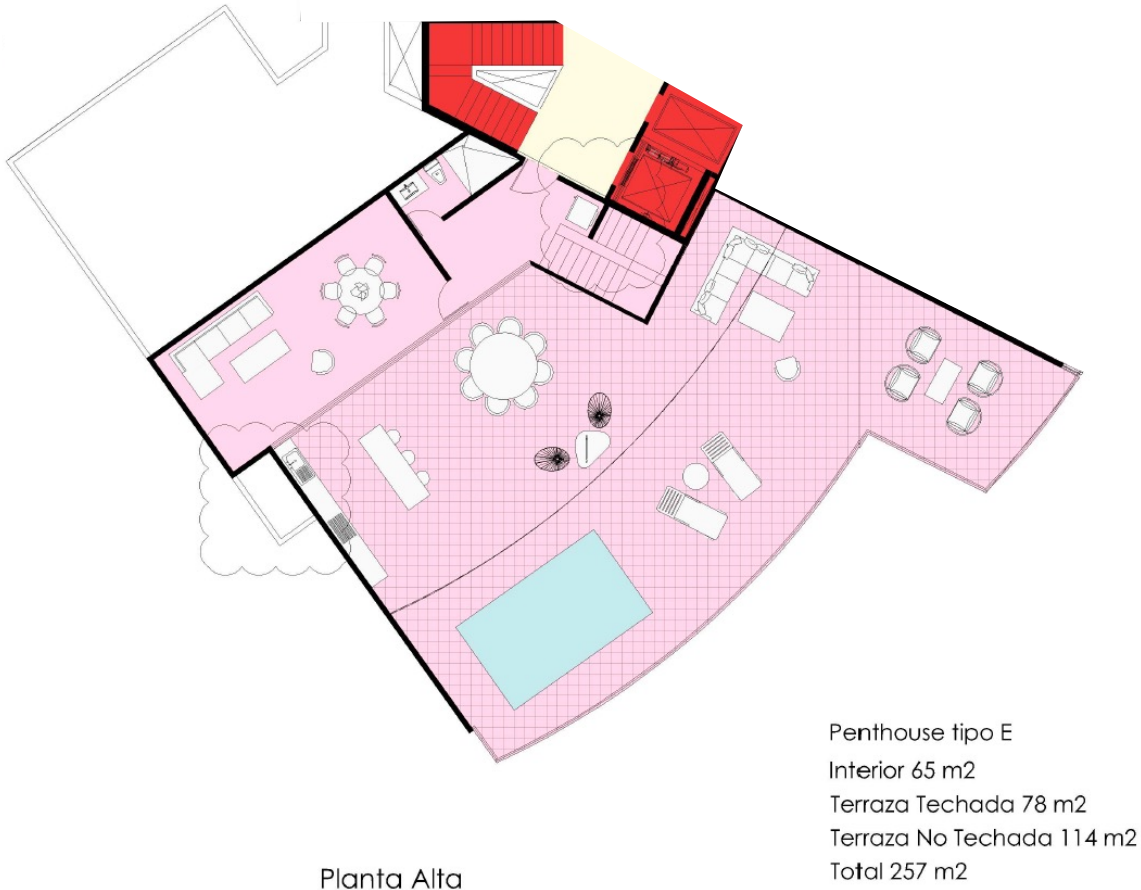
PLANTA ALTA PENTHOUSE TIPO E.
